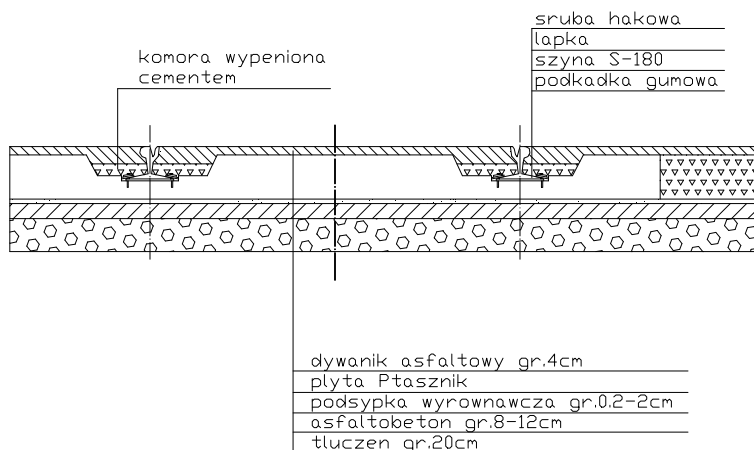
Torowisko na podkładach betonowych zabudowane płytami.
